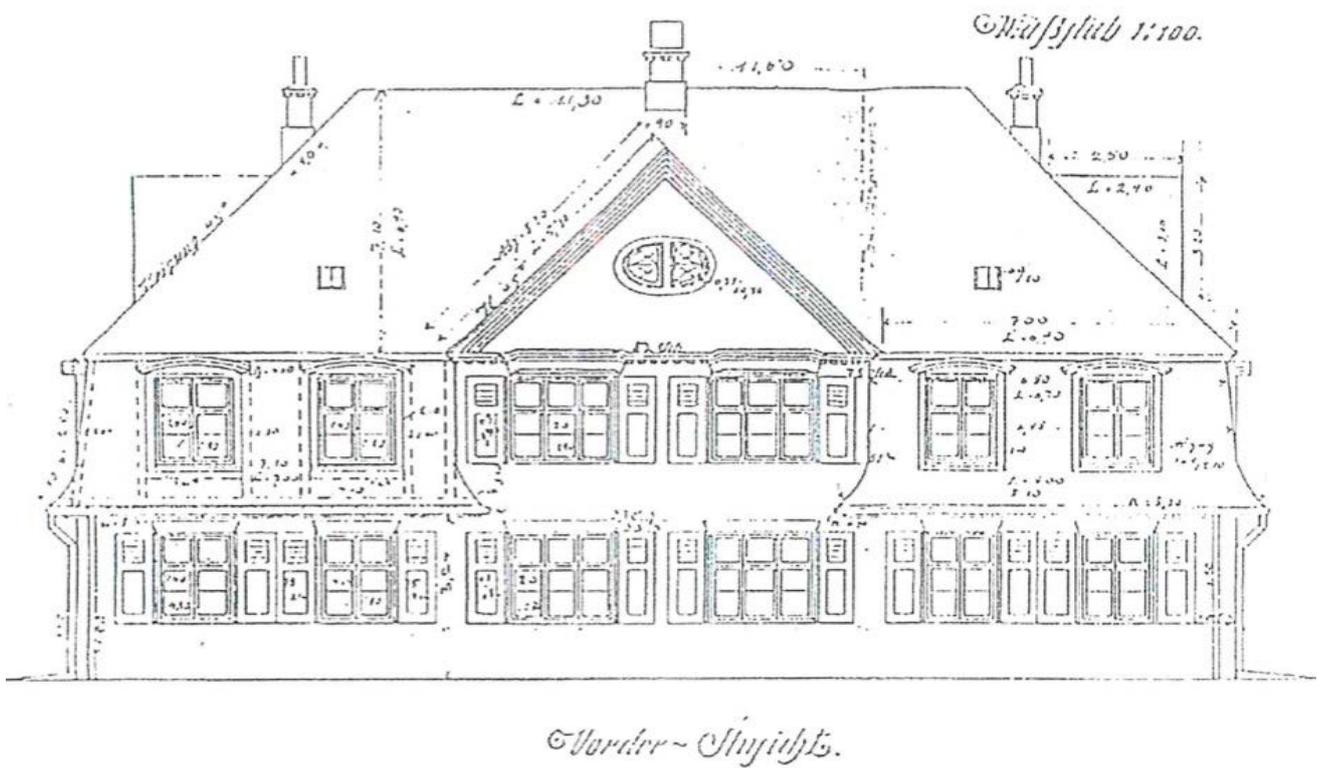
Delbrückstraße 12 -14 Haustyp G2 - Historische Zeichnung
